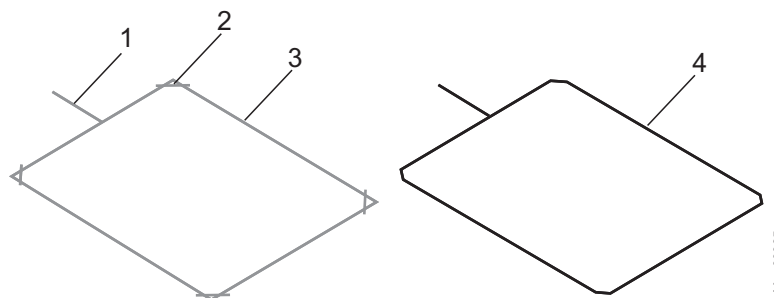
Placera induktionsslingor i bitumen, asfalt eller betong
